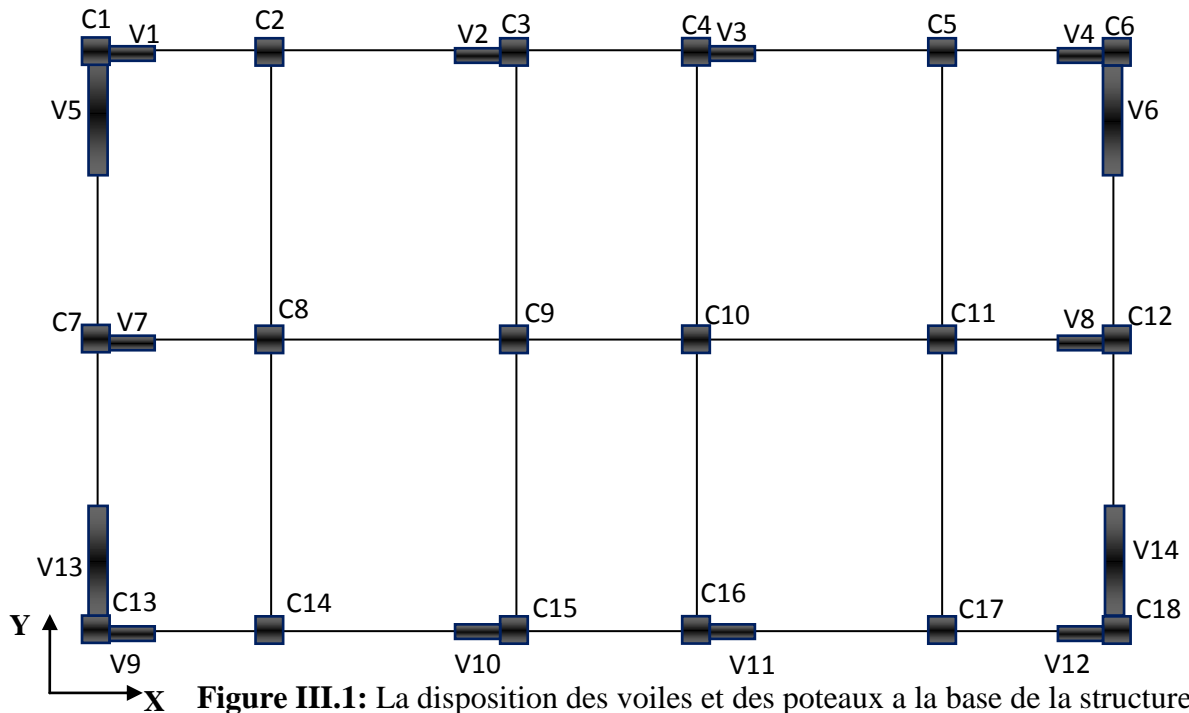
La disposition des voiles et des poteaux a la base de la structure
